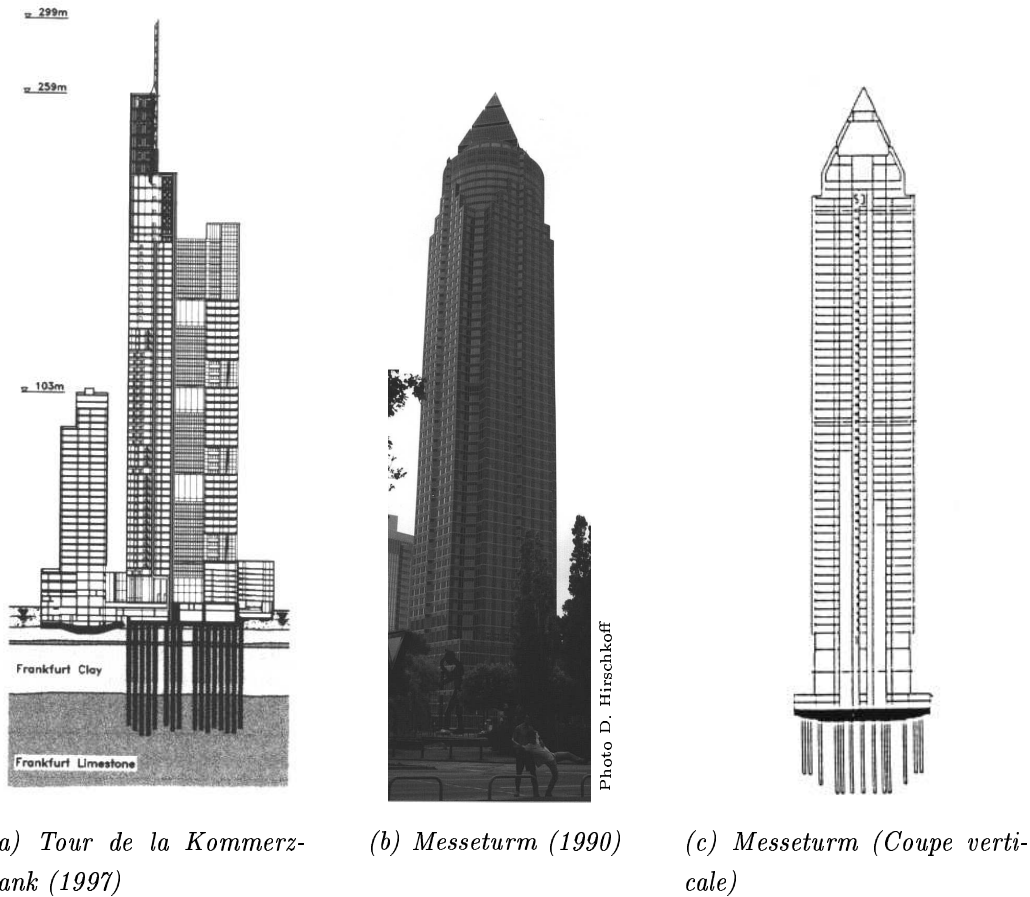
Exemples d'ouvrages sur radiers de pieux (Sudret (1999) [75])
